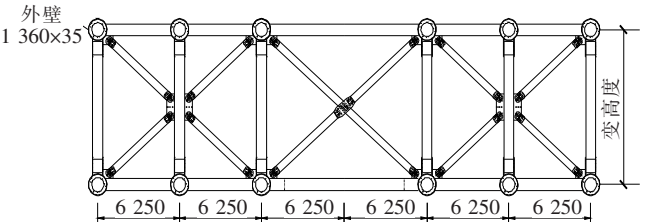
空心钢管混凝土拱肋横截面图(单位:mm)
